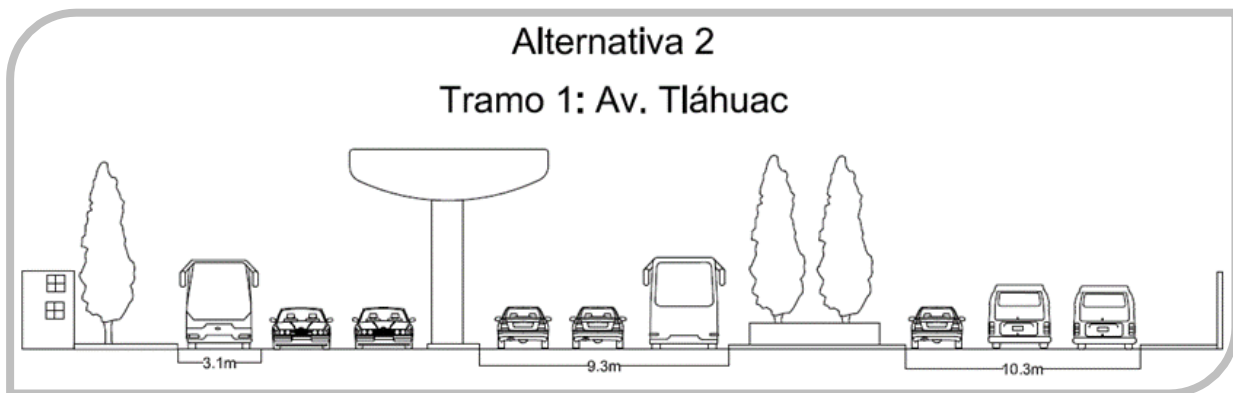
XVIII: Sección transversal en Av. Tiáhuac, tramo 1, alternativa 2 (elaboración Propia)
